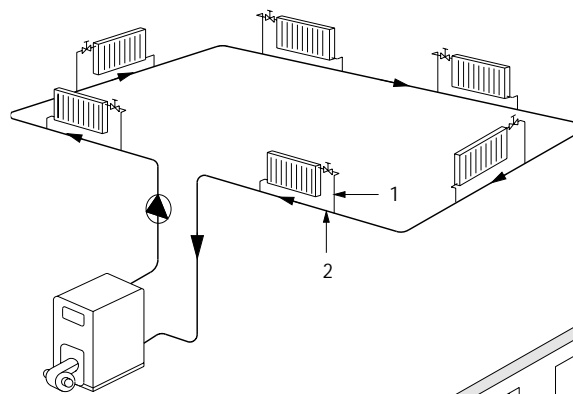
Principe d'une installation de chauffage central à eau chaude (monotube).
